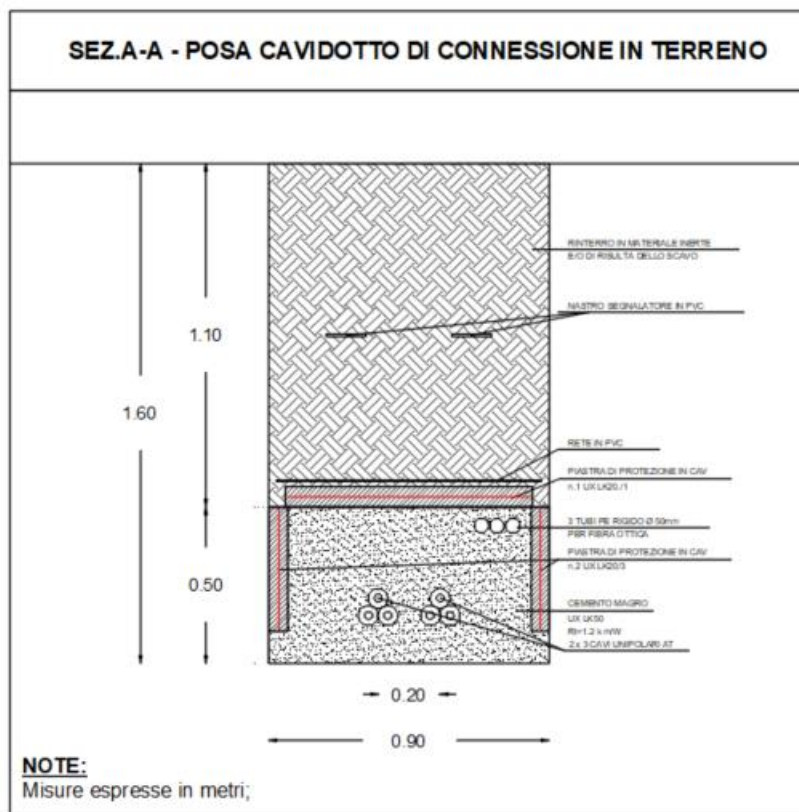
Tipologico di posa in terreno per il cavidotto di connessione
